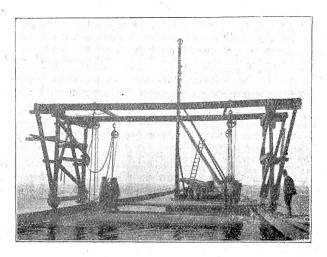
Lauftran, mit Betonelement, vor dem Abfenten.
